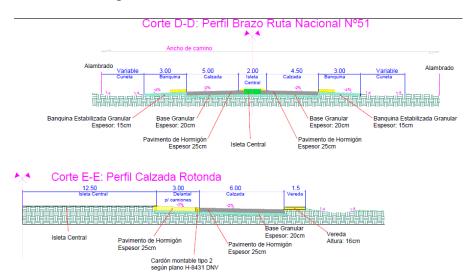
Perfiles transversales de rotonda proyectada.
